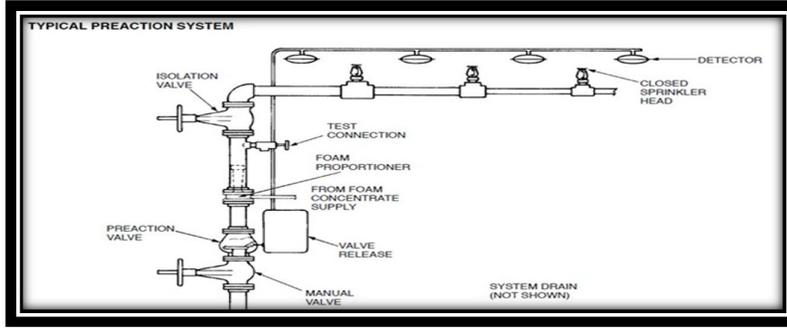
/2) صاعد نظام المرشات الجاف Dry Riser Sprinklers System
